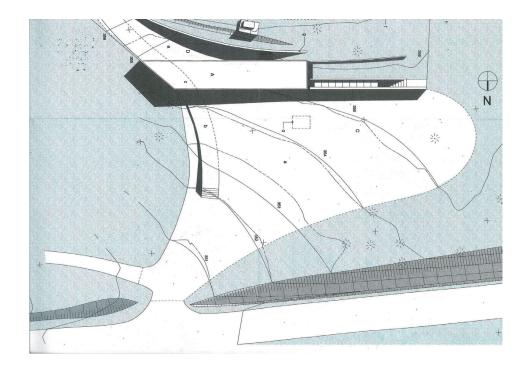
Projeto do Centro Interpretativo e de Acolhimento, Planta de Implantação (parcial), Estudo Prévio (2000)
